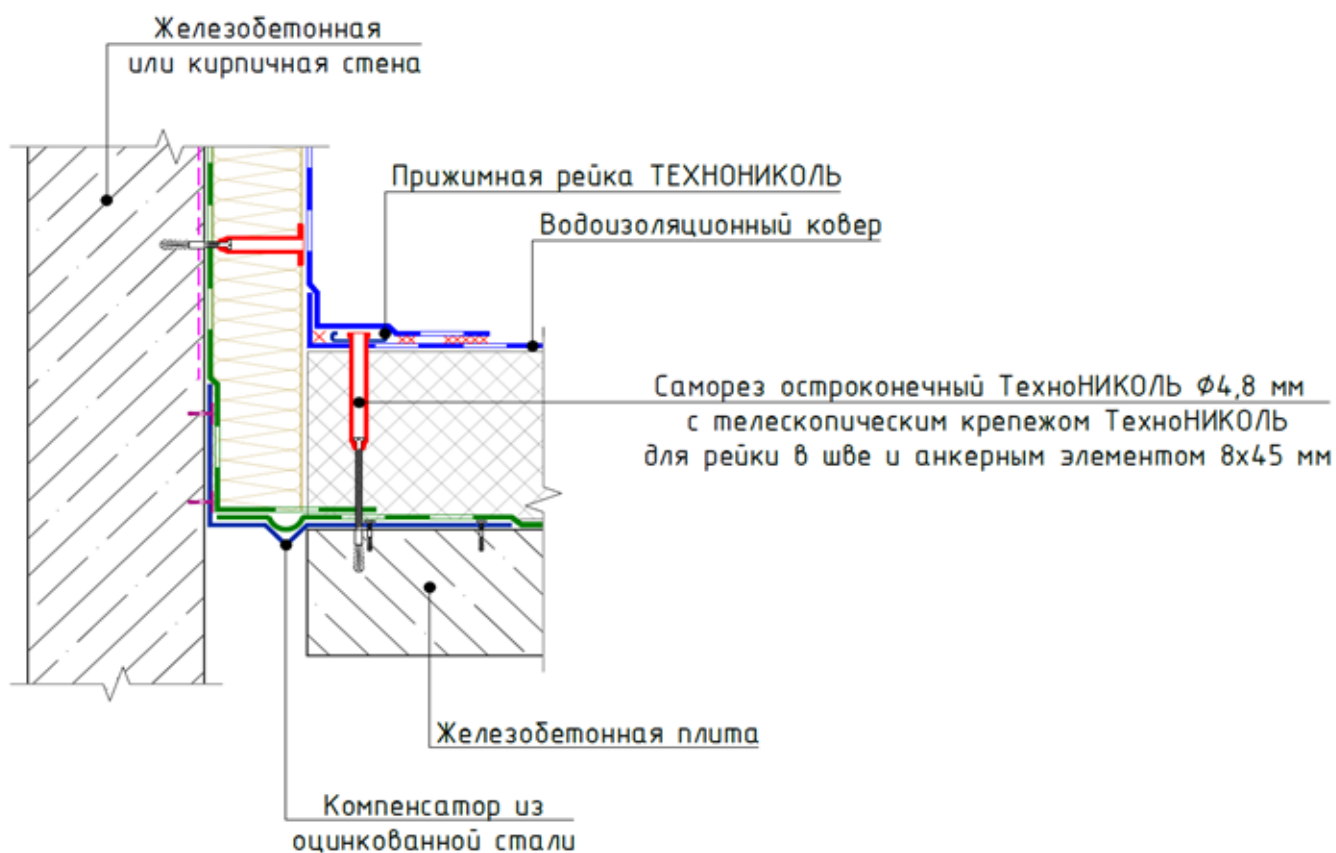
Крепление прижимной рейки в зоне деформационного шва в примыкании к стене к железобетонному основанию
